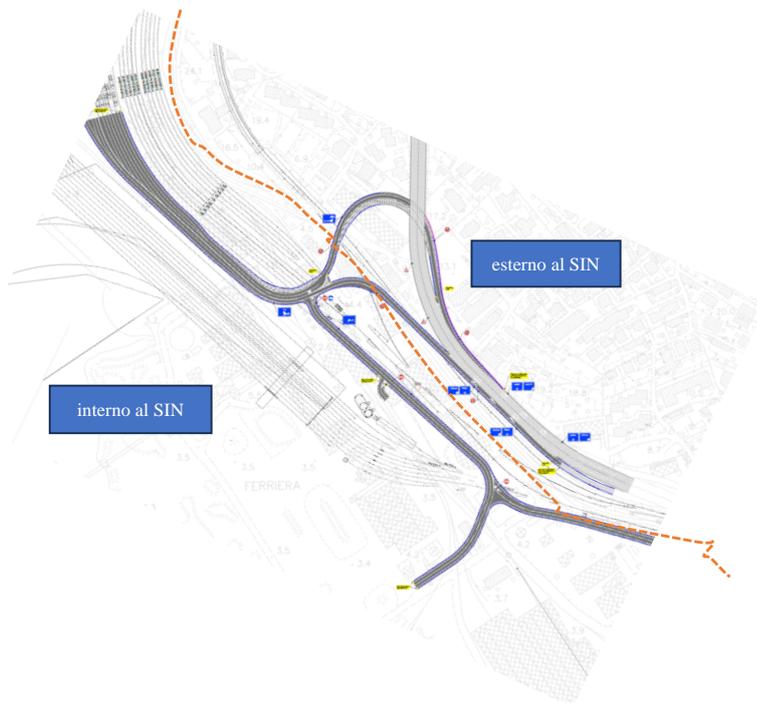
Dettaglio delle opere stradali e ferroviarie, le cui fondazioni e rilevati costruiscono le opere interferenti oggetto della presente istanza
